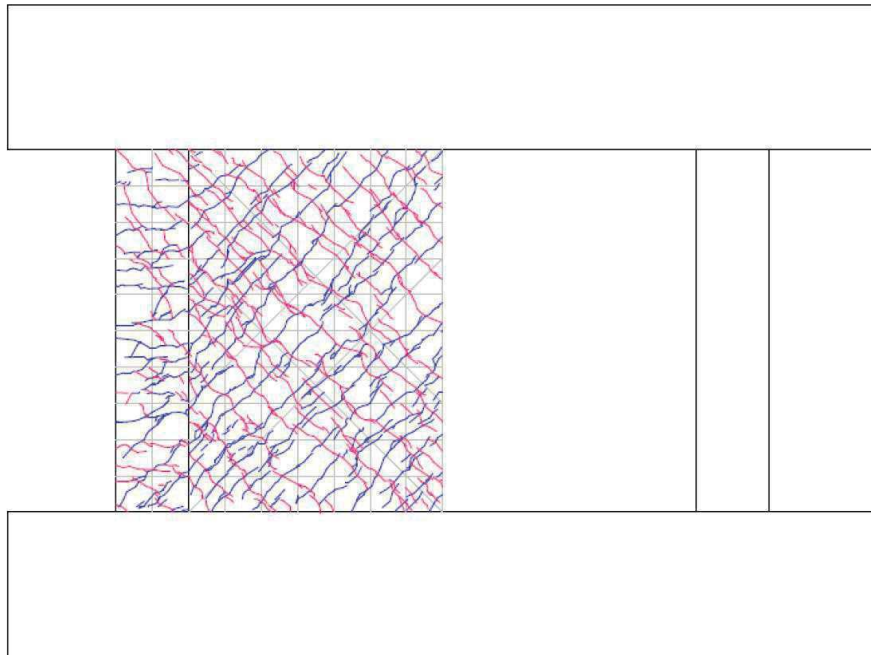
試験体 S-13-DII 6/1000rad. ひび割れ図
